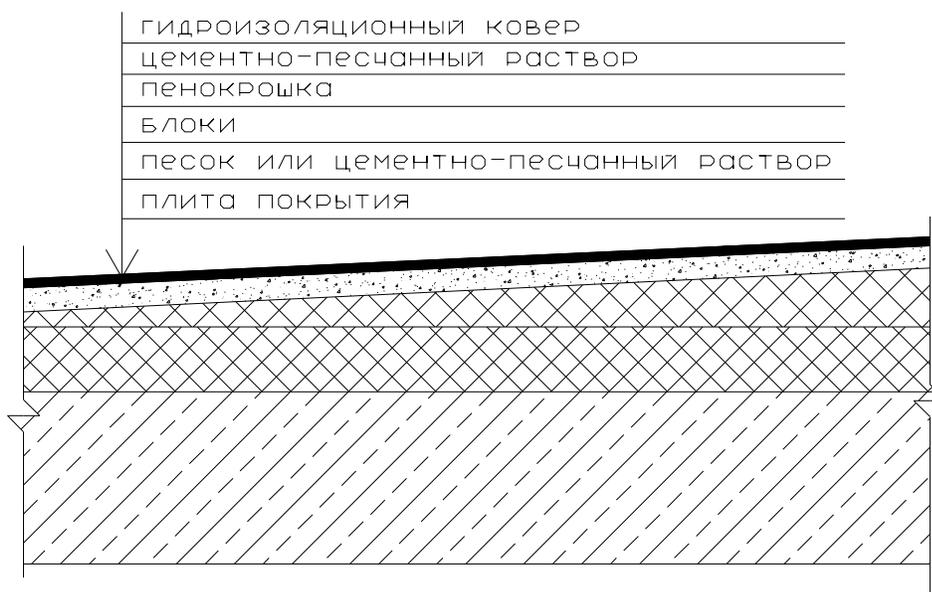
Тепловая изоляция совмещенной плоской кровли из блоков с разуклонкой из пенокрошки
